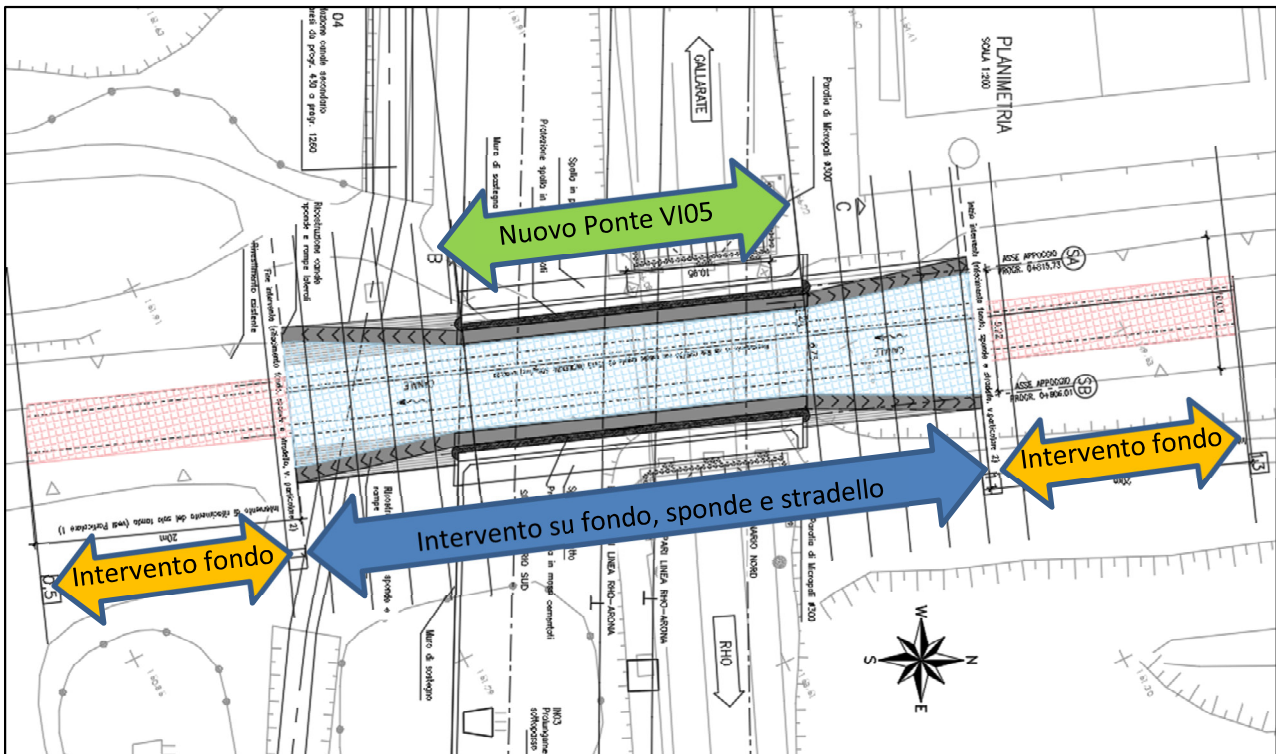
SISTEMAZIONE IDRAULICA DELL'ALVEO
